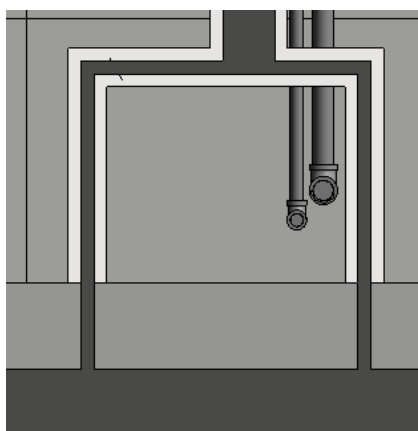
Conexión vertical equipo interior – exterior (vista planta)
